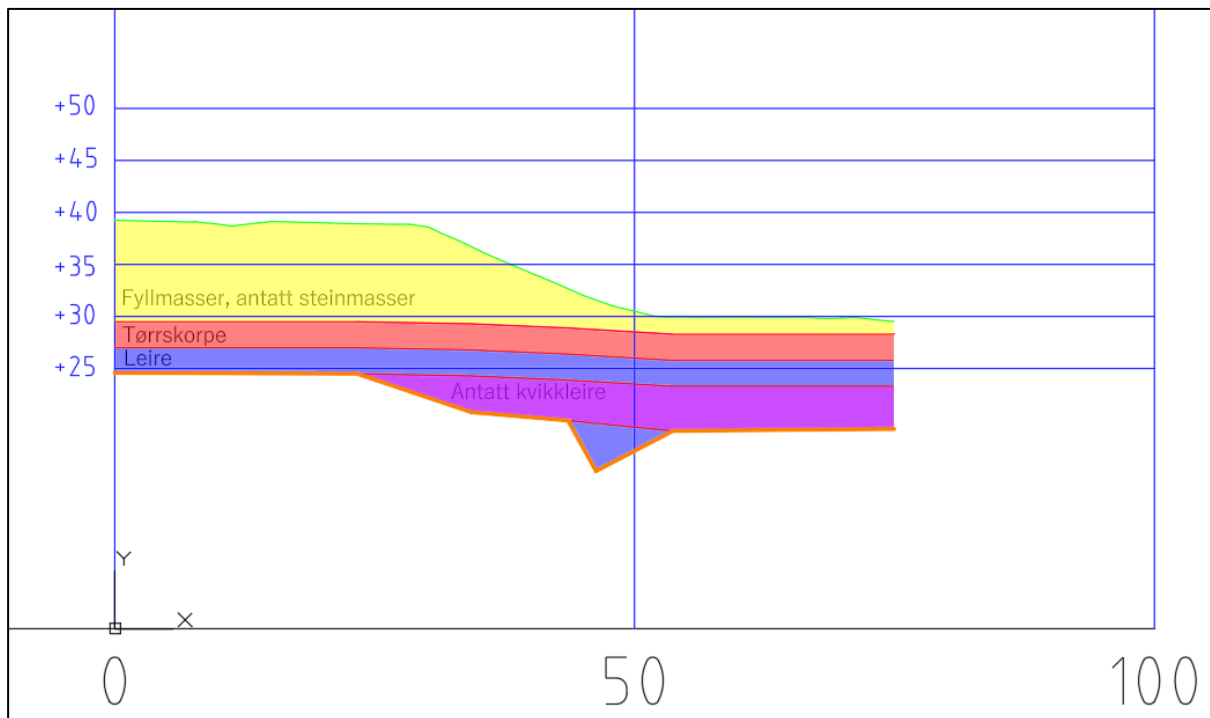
Beregningsprofil med borpunkter fra Terraplan, 2002 [3].
